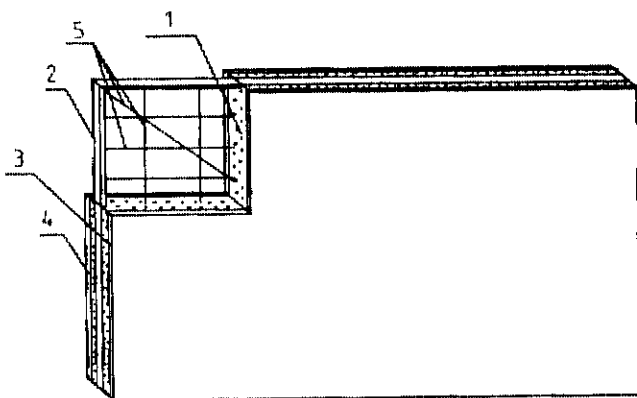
Схема фрагмента панели наружной стены из полимеркомпозита
